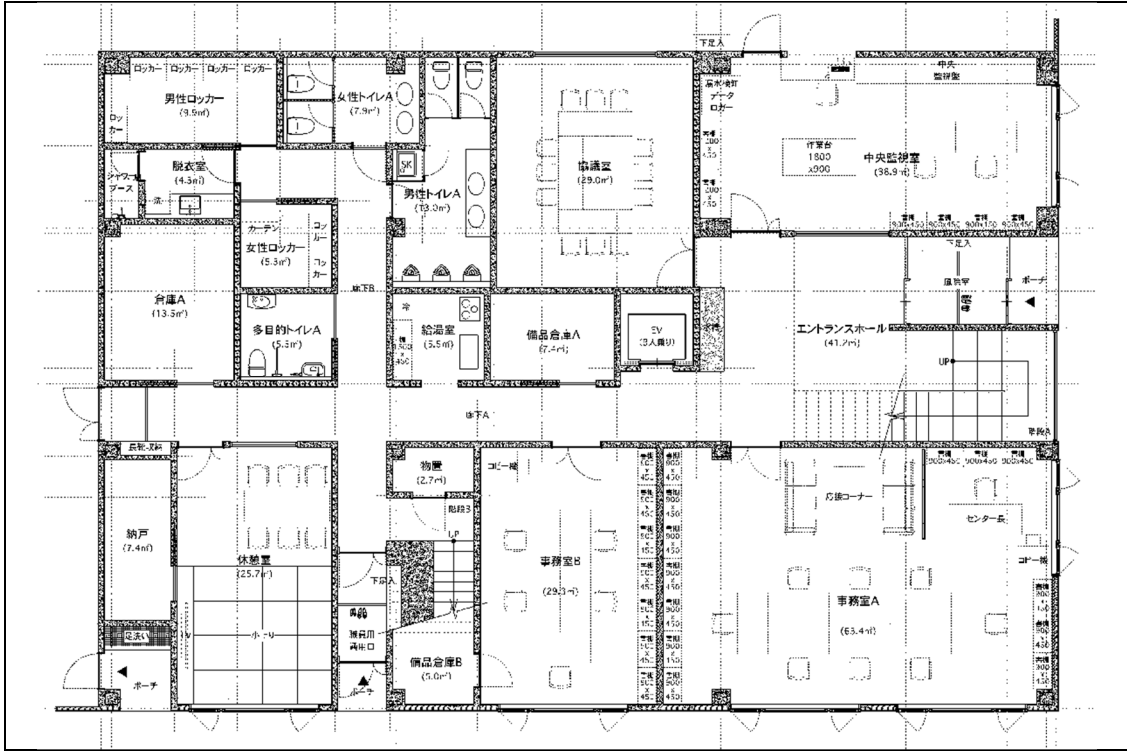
浸出水処理施設・管理事務所部（1階平面図）
